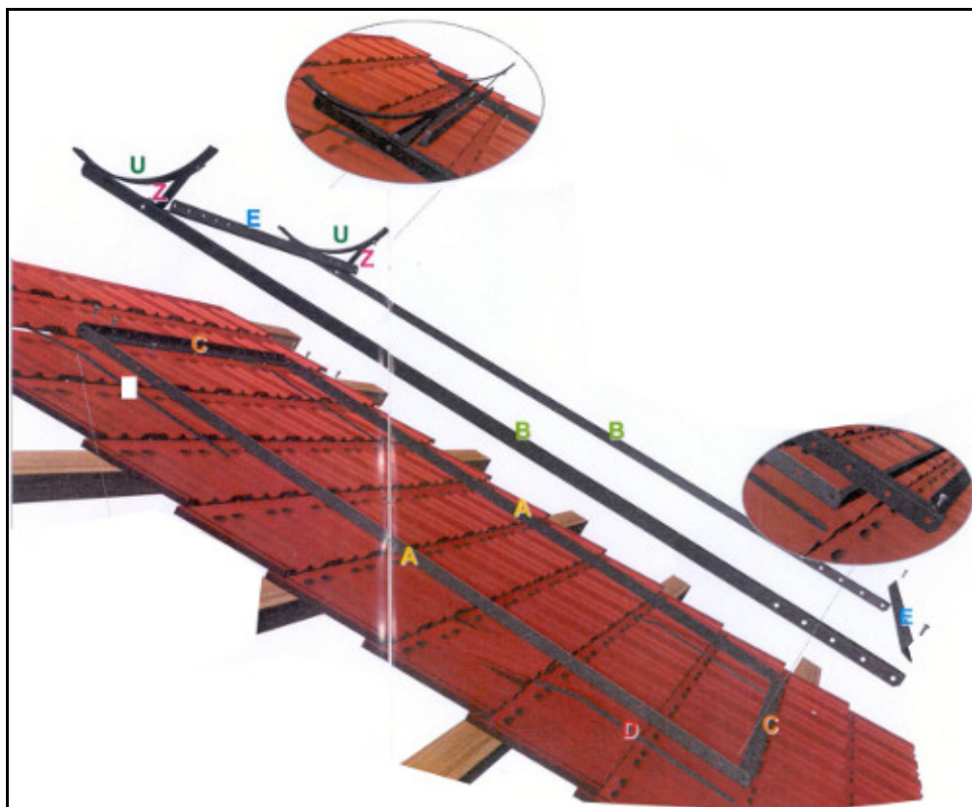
Accessoires de fixation pour montage sur toiture en tuiles mécanique inclinée à 32° maximum
